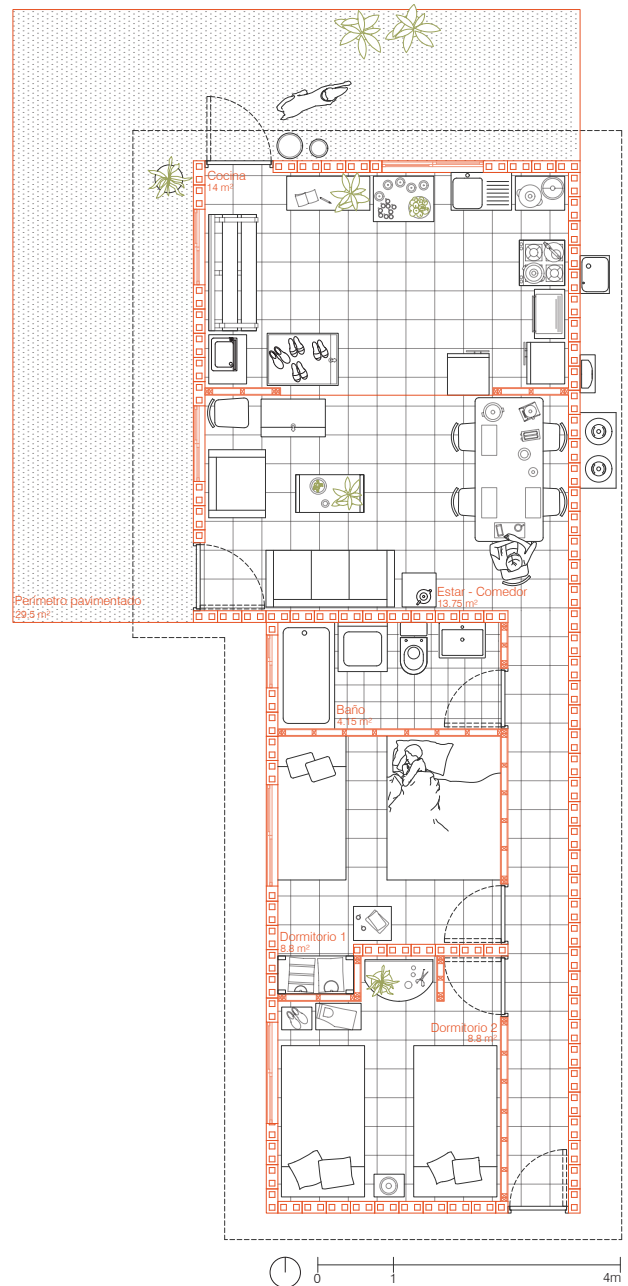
Plano Casa Saavedra. (Elaboración propia en base a planos de Morales, 2021 y visita a terreno).
